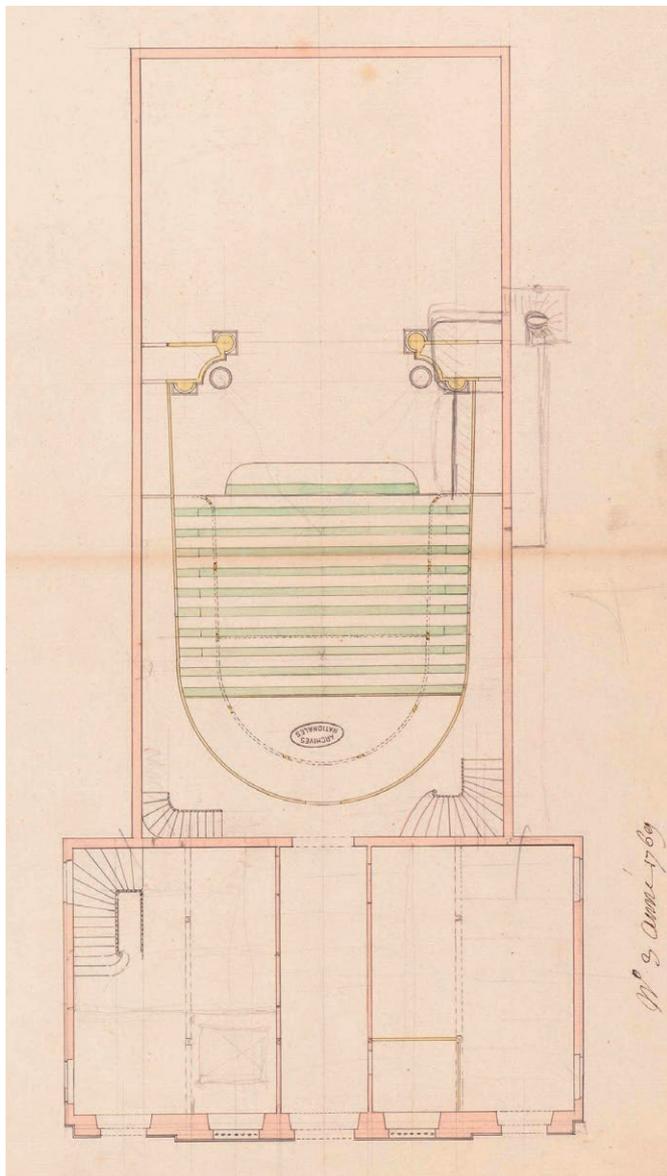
Planche A.N. N/III/Seine/1030/34, montrant le plan du rez-de-chaussée de BT-PRO1.
